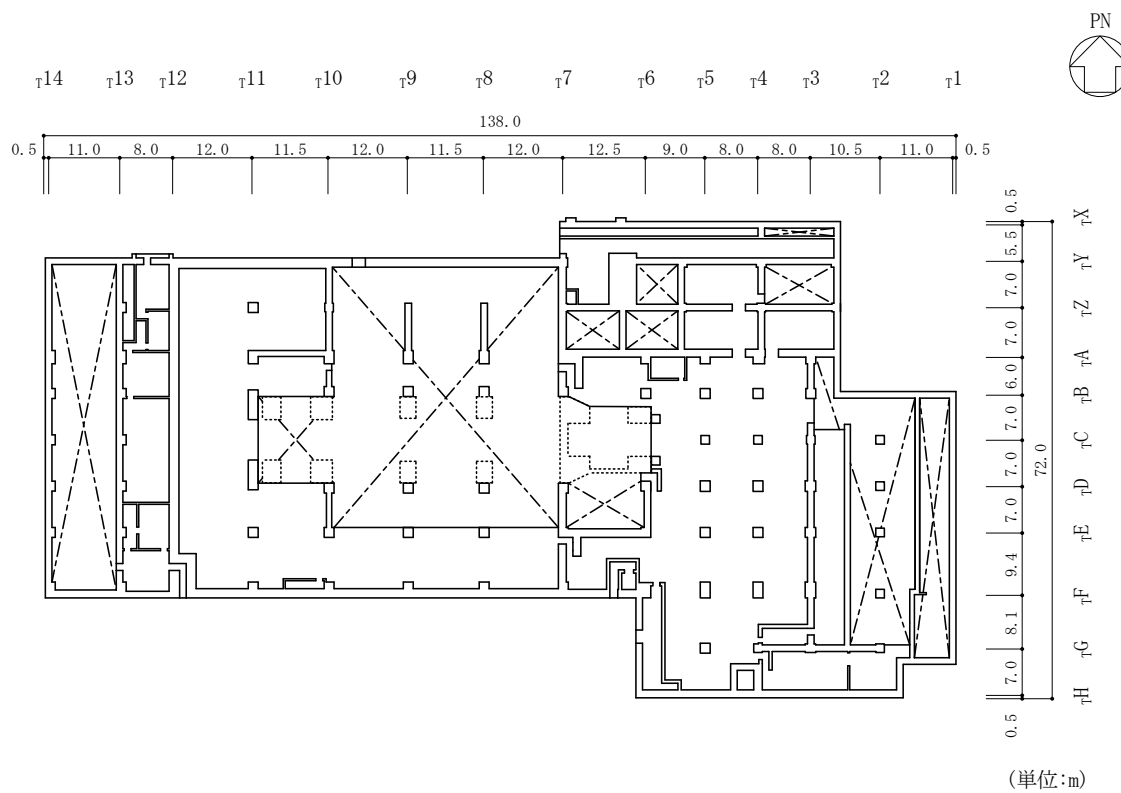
(2) タービン建物の概略平面図 (EL 5.5m)
